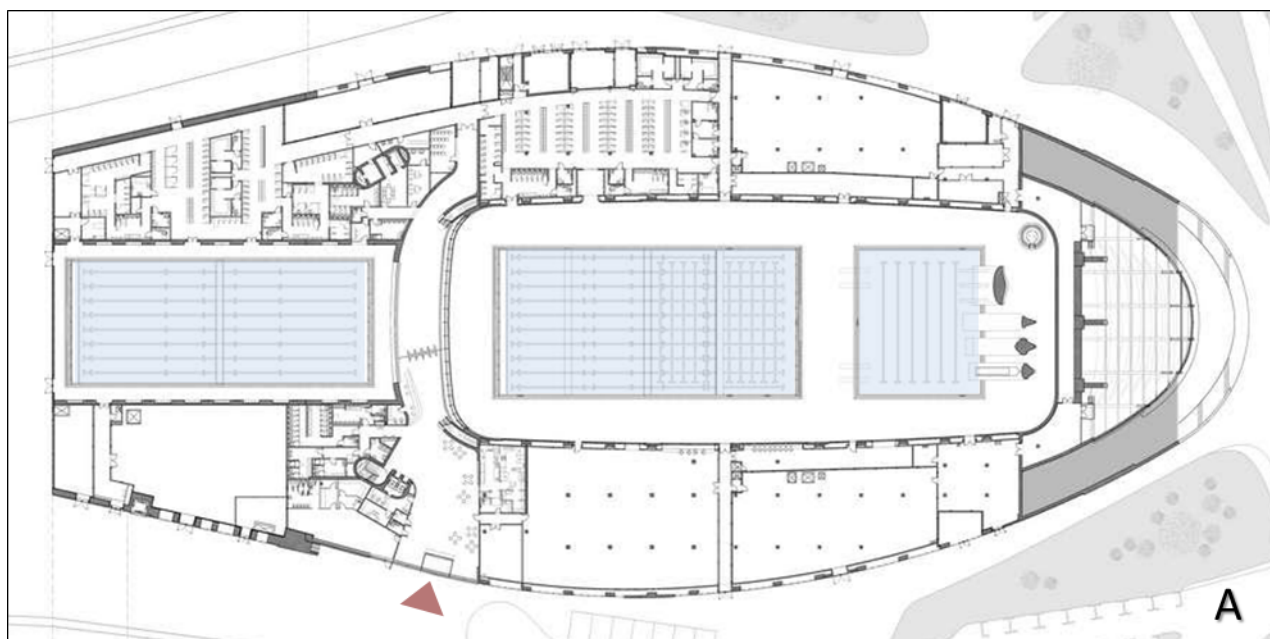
Projeto London Aquatics Centre. A – Planta do piso térreo; B – Planta piso 1; C – Corte longitudinal. Entradas público. Adaptado de (Archdaily, 2011).
